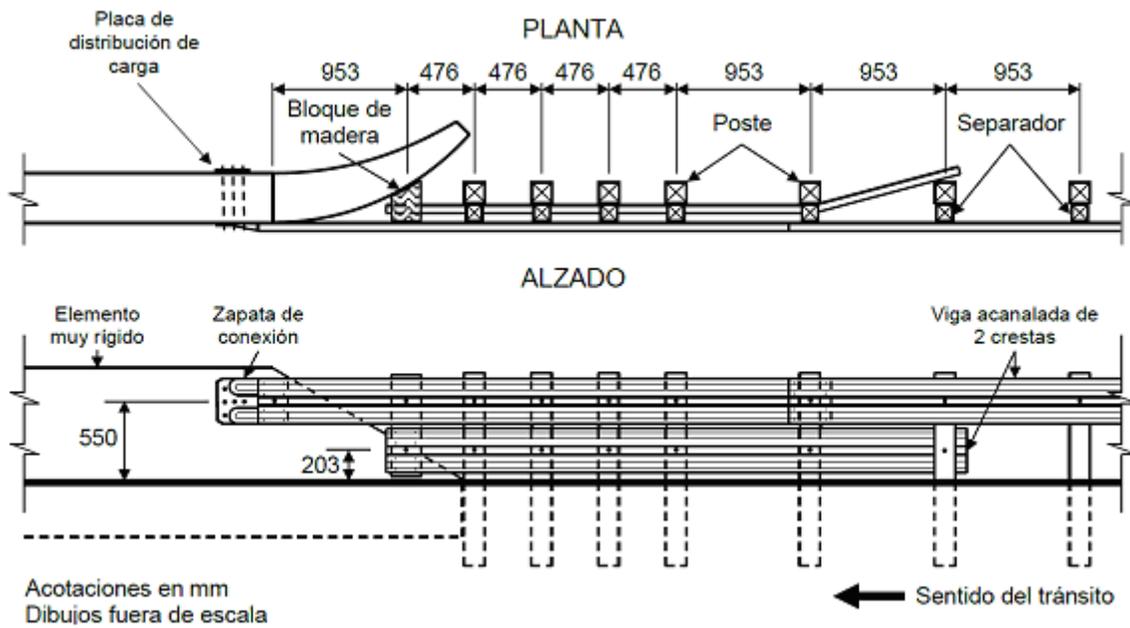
Transición de barrera metálica de doble bandas a muro curvo
